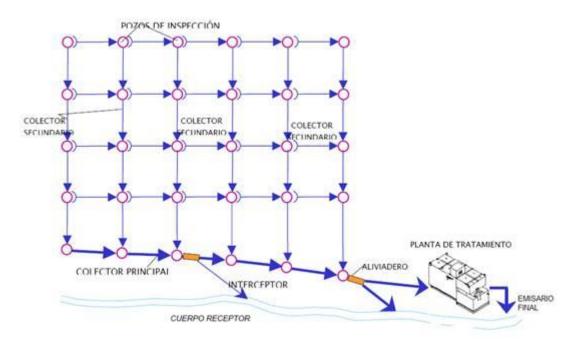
Ejemplo de sistemas de alcantarillado pluvial.
